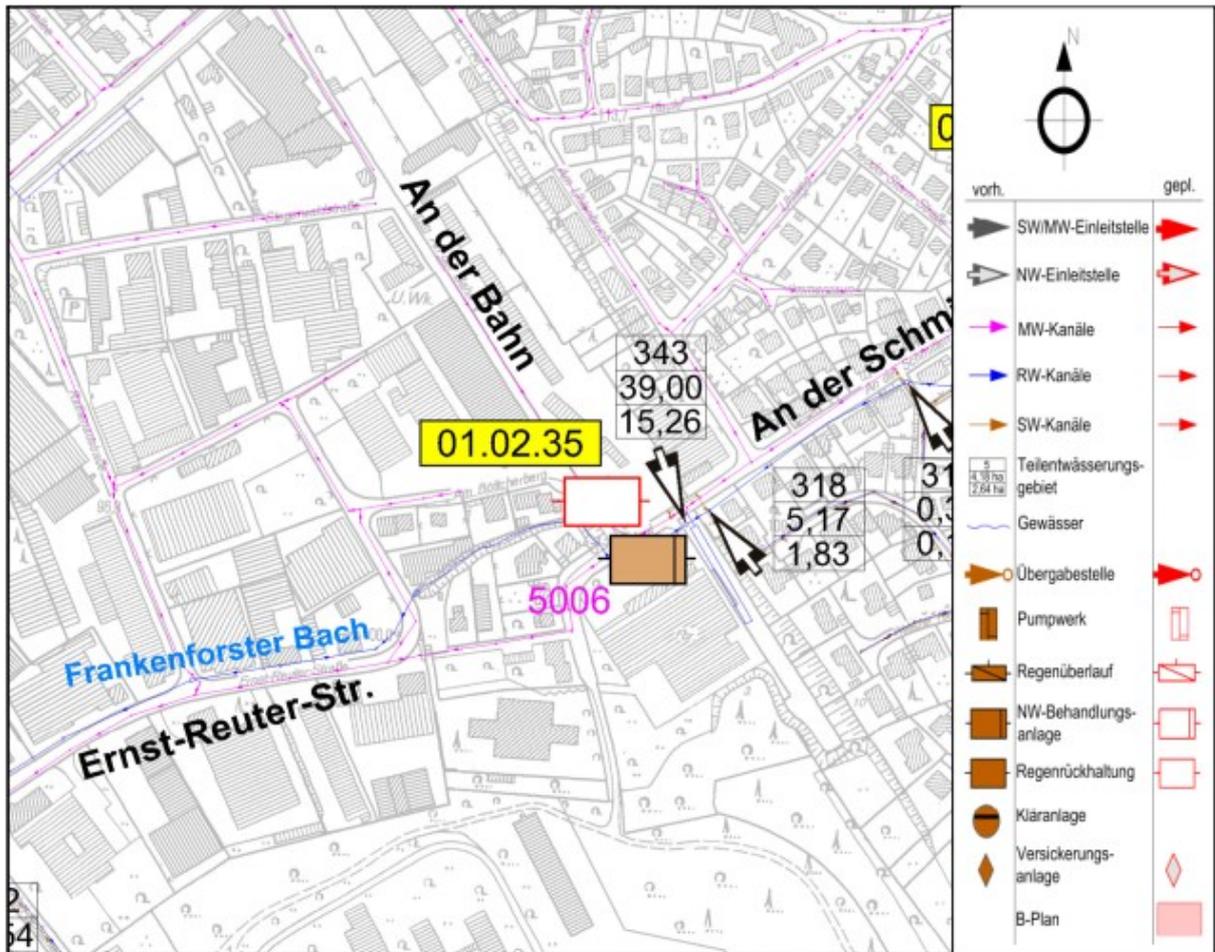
Auszug aus Lageplan (unmaßstäbliche Darstellung)
